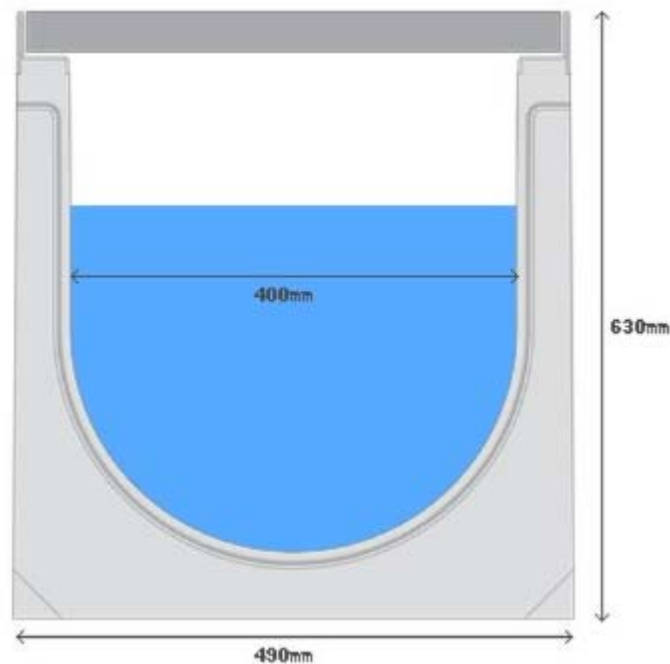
Particolare sezione canaletta tipo "FASERFIX SUPER 400 tipo 01H"
